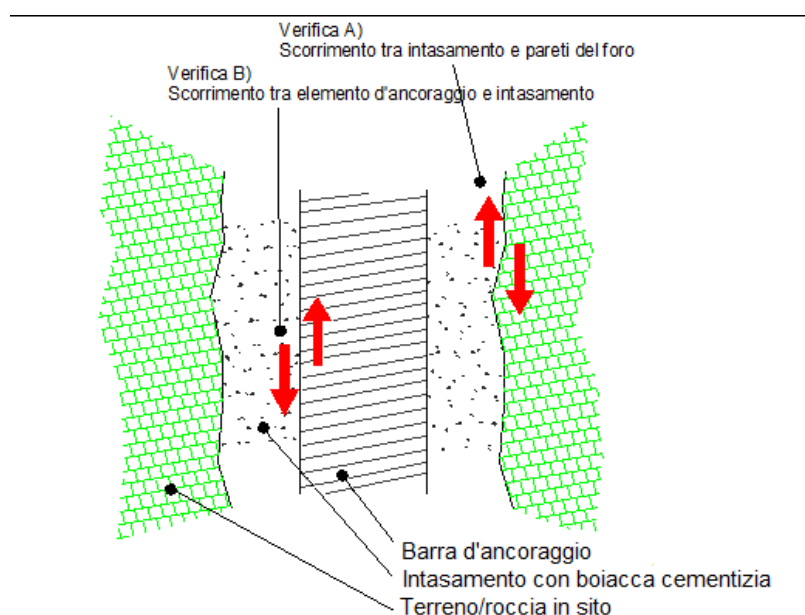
Verifiche rispetto allo sfilamento dell'ancoraggio.
